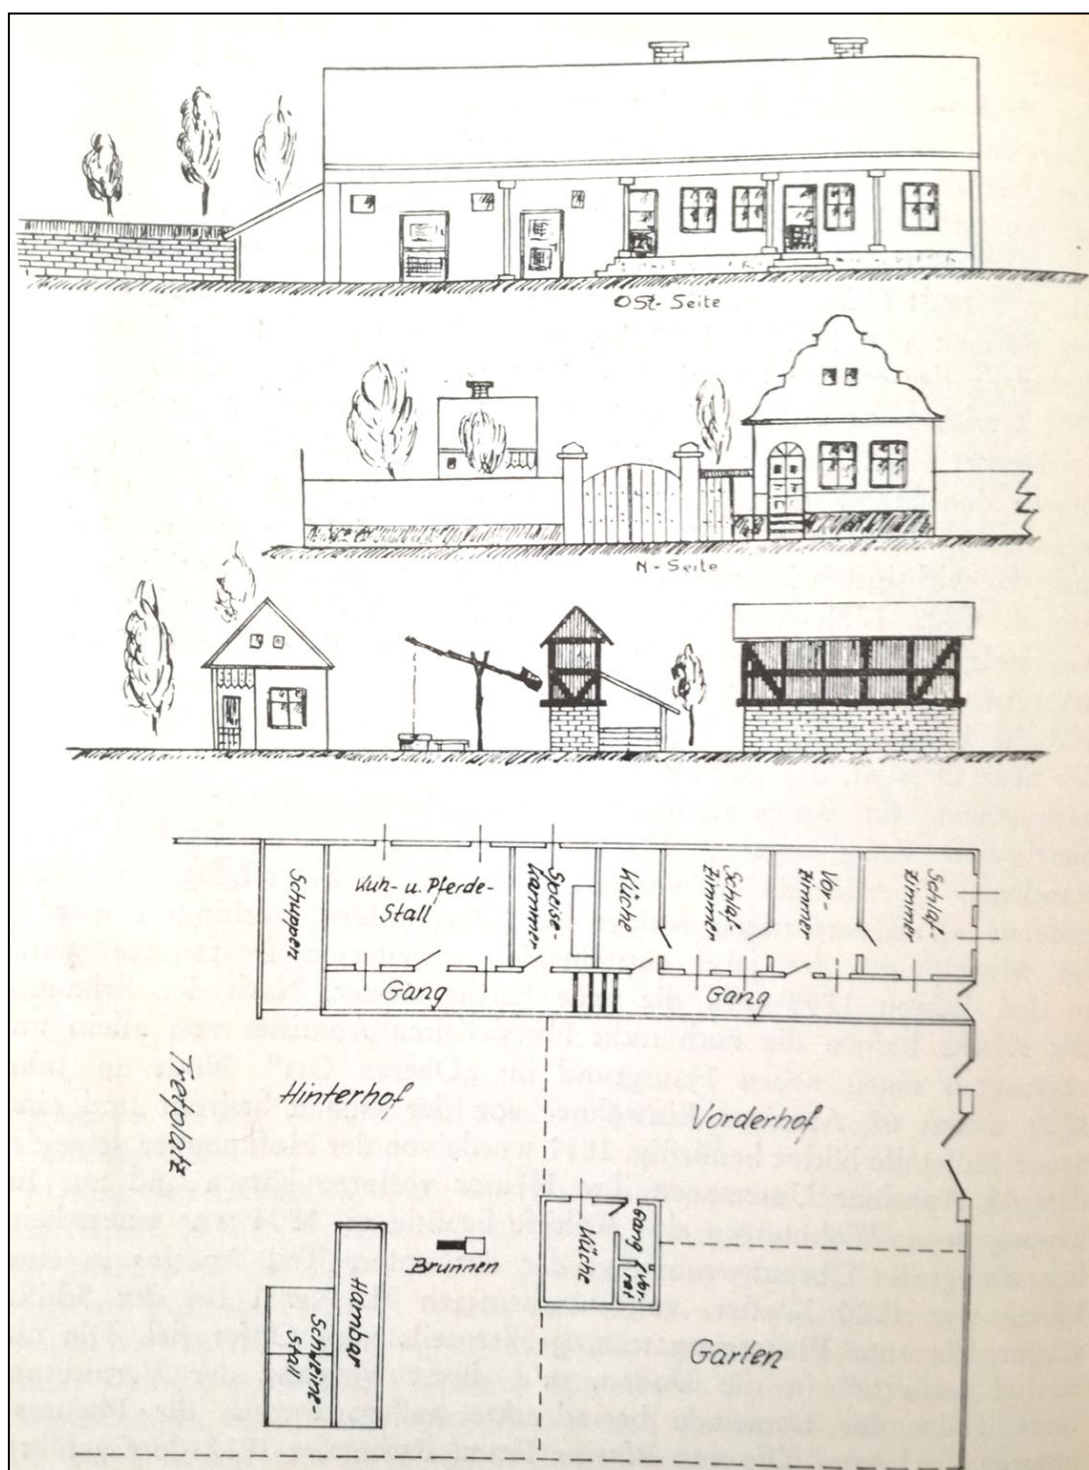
Grundriss und Ansichten eines einfachen Langhauses;
